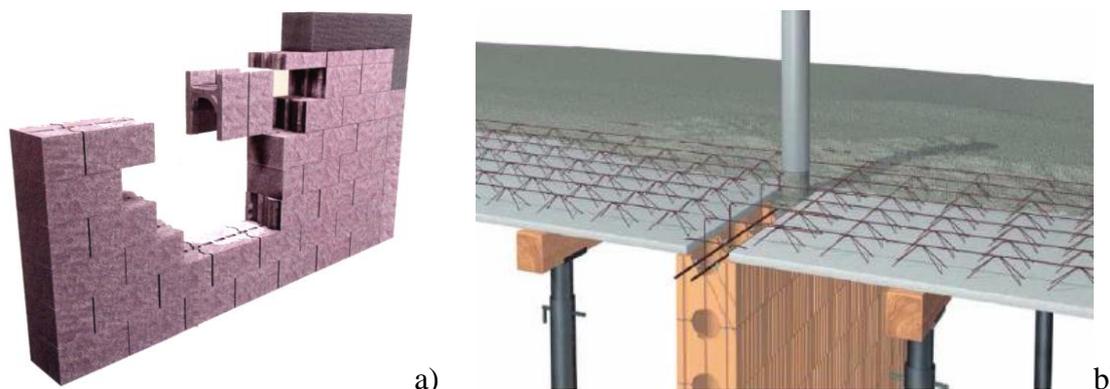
Sistemas industrializados de alvenaria estrutural: a) em blocos de betão e b) com integração de laje
